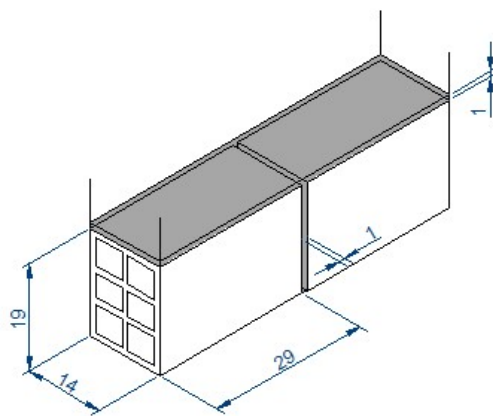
Detalhe do módulo para carregamento de alvenaria de 20 cm
